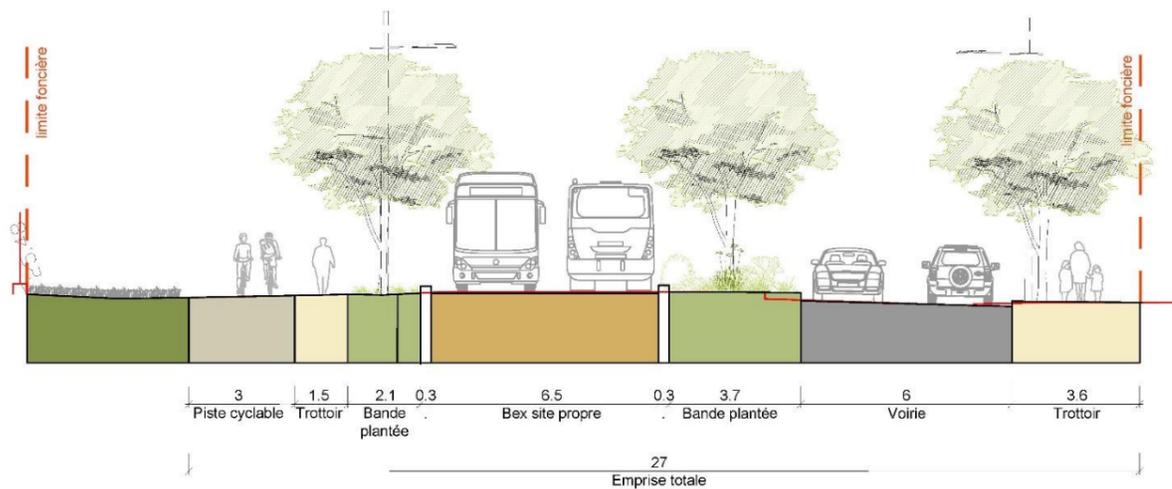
Coupe type sur l'avenue de Thouars Sud
